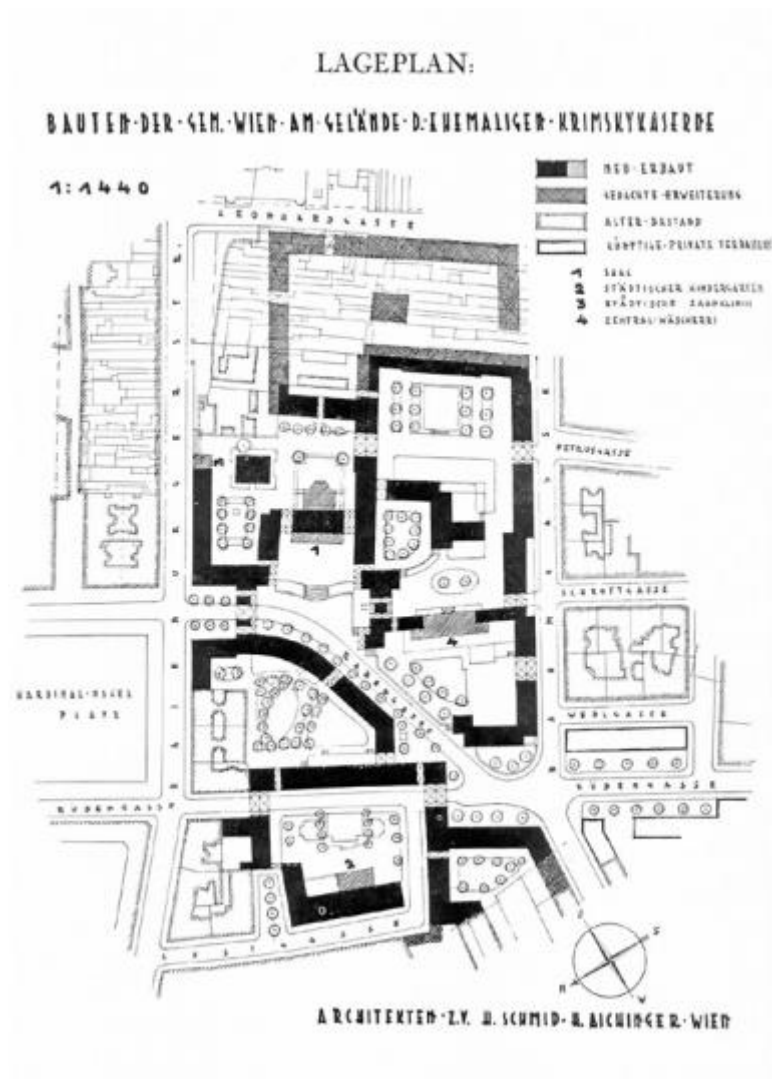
Grundriss des Rabenhofs⁹⁵
